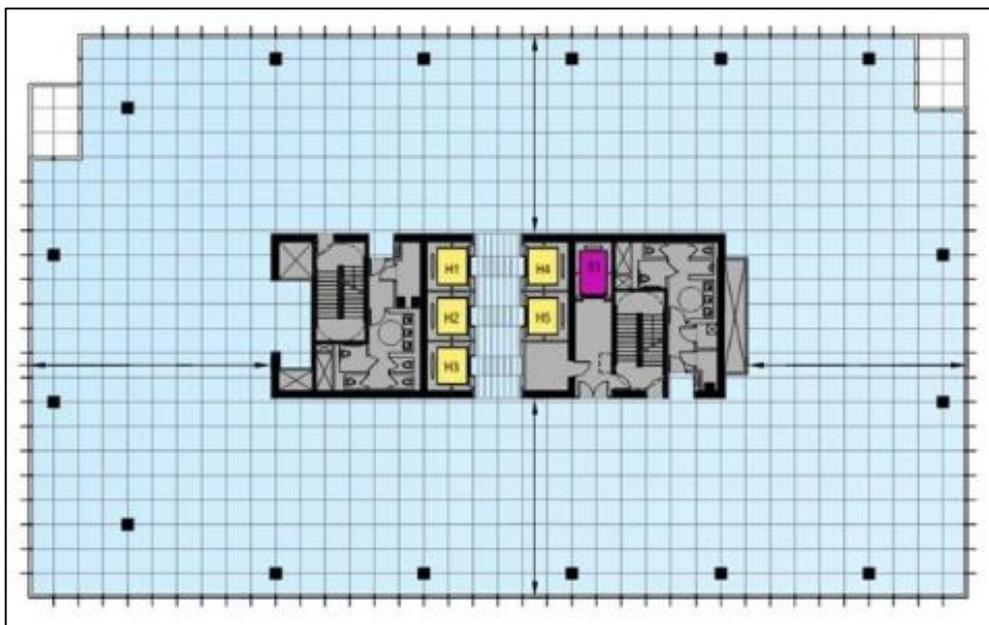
plan de structure de la tour Al Hilal source : <https://www.archdaily.com/>
